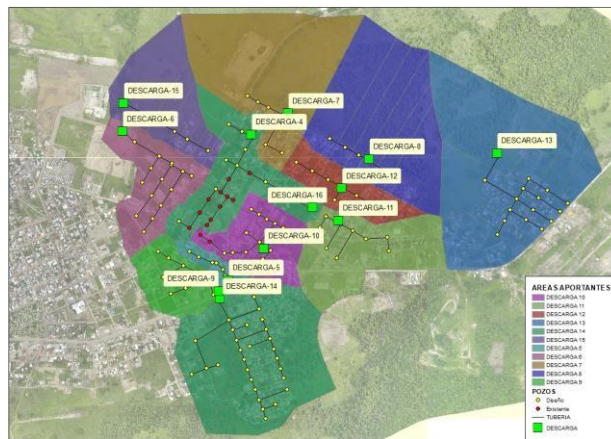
Área de Aportación Fase 3 Alcantarillado Pluvial – Descargas.
